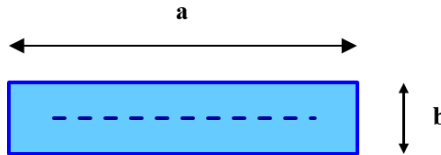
Sección transversal al eje longitudinal de un dren prefabricado (PVD).
